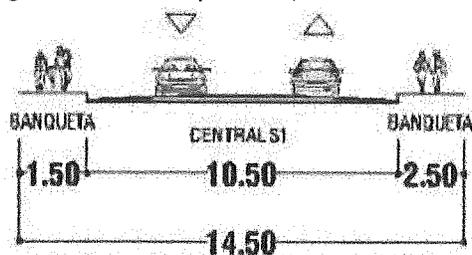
Estructura vial en la zona, C. Alfredo Breceda
